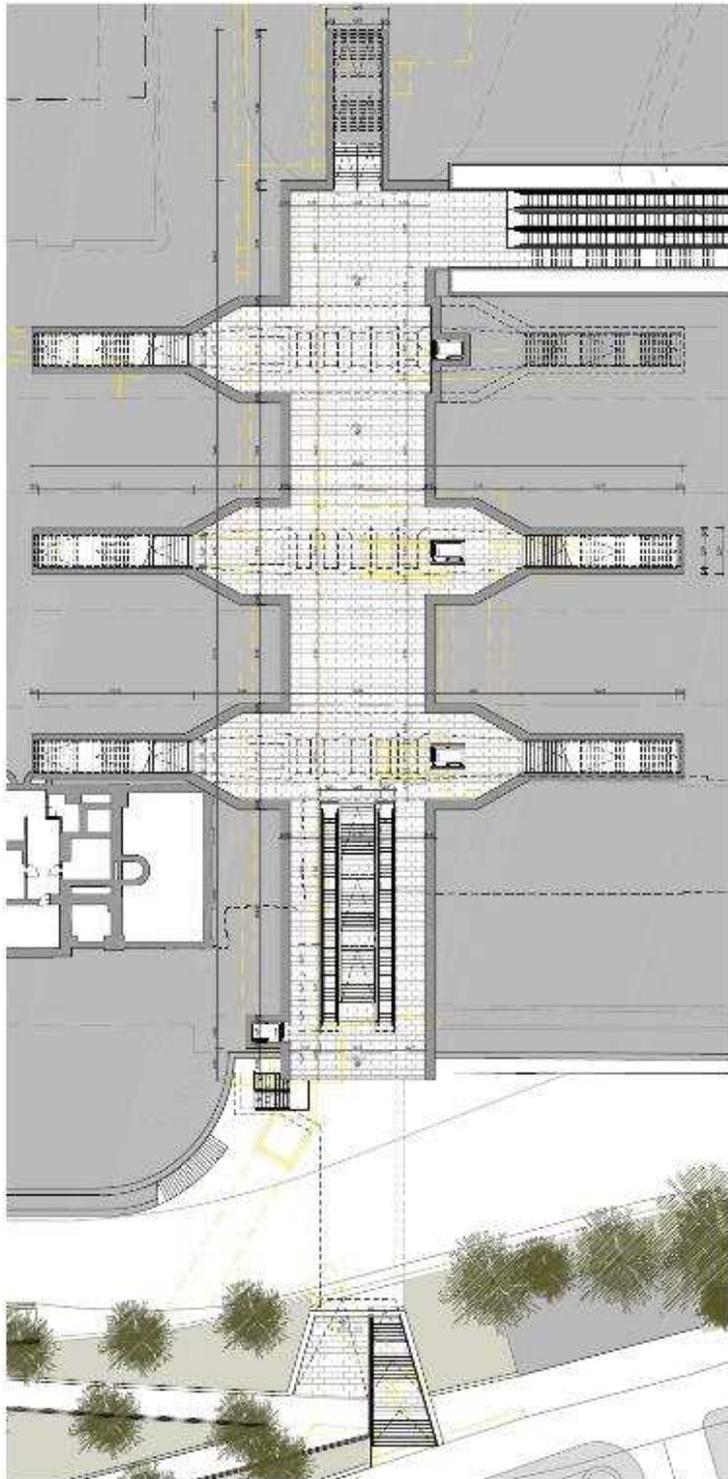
Planimetria generale livello -1 del nuovo sottopasso.
